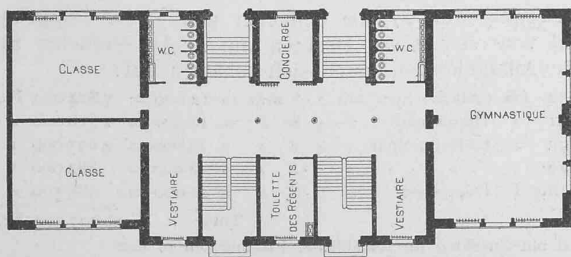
Plan du Rez-de-Chaussée. — Echelle 1 : 500.
